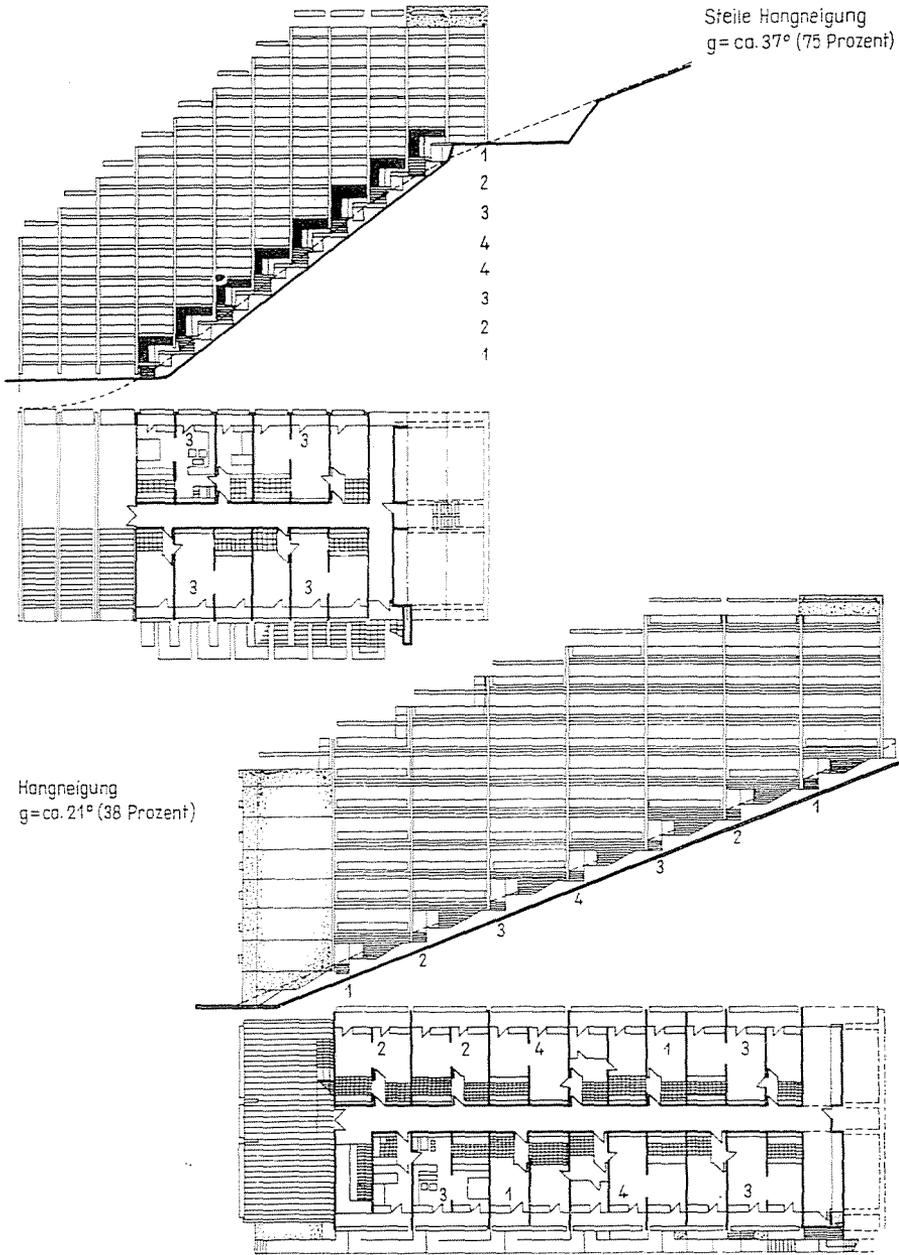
Der gleiche gestaffelte Grundriß eignet sich auch für Hangbebauungen. Es ist möglich, Häuser bis zu 12 Geschossen senkrecht zum Hang anzuordnen
